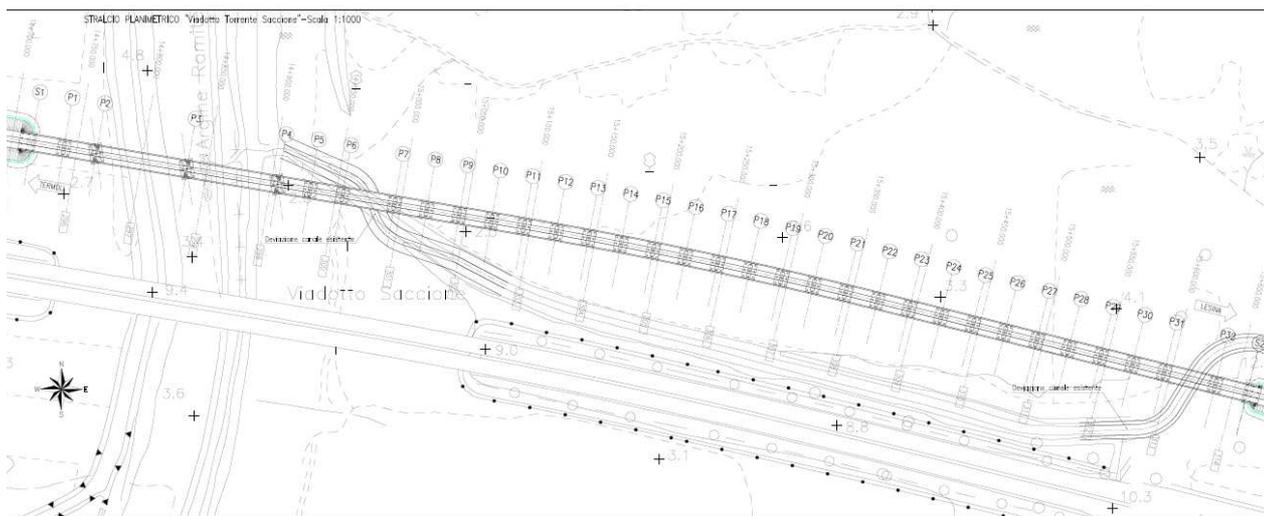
Viadotto sul torrente Saccione: stralcio planimetrico
